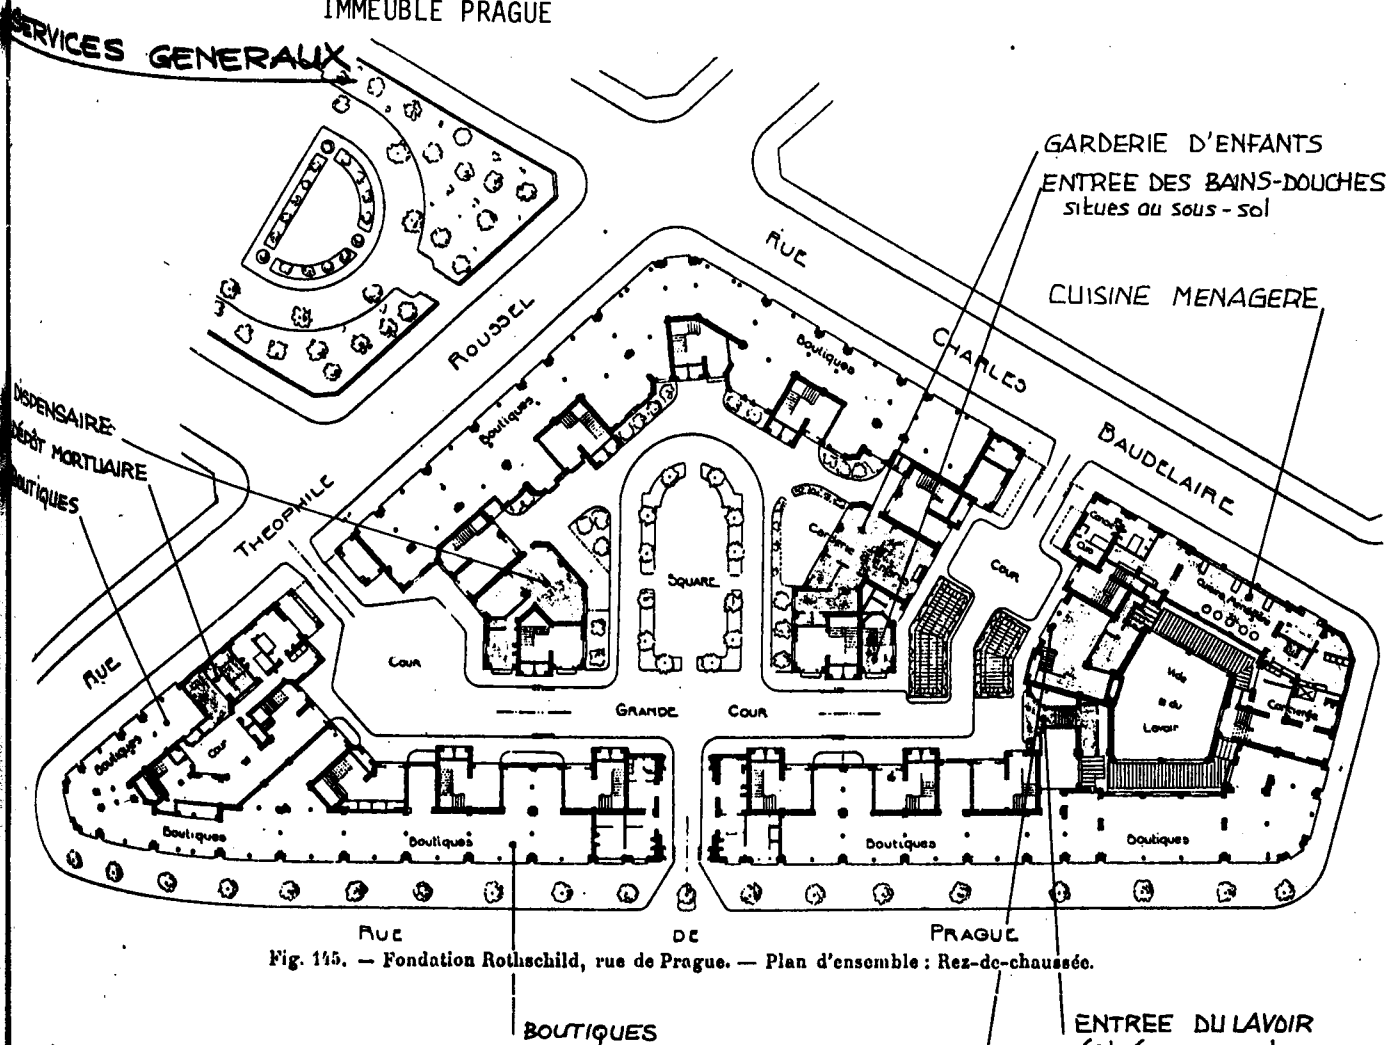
Fondation Rothschild, rue de Prague. — Plan d'ensemble : Rez-de-chaussée.
